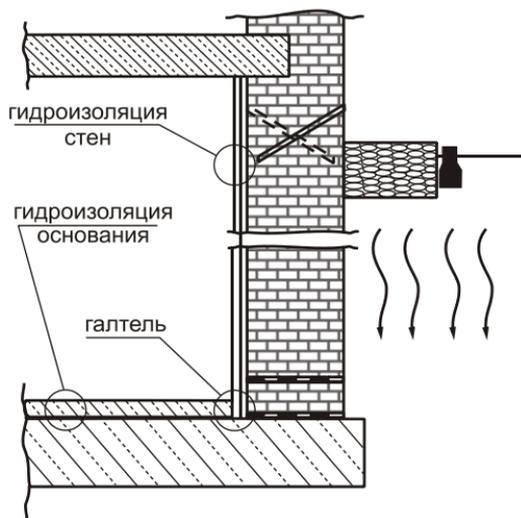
Схема гидроизоляции подвала обмазочными материалами
